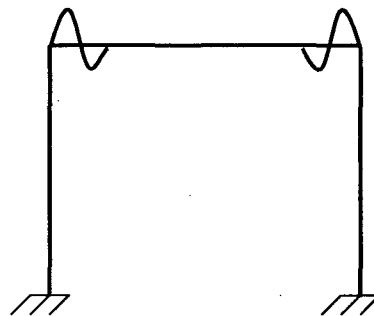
Modelagem para “mola” aplicada somente na viga de um pórtico plano.
